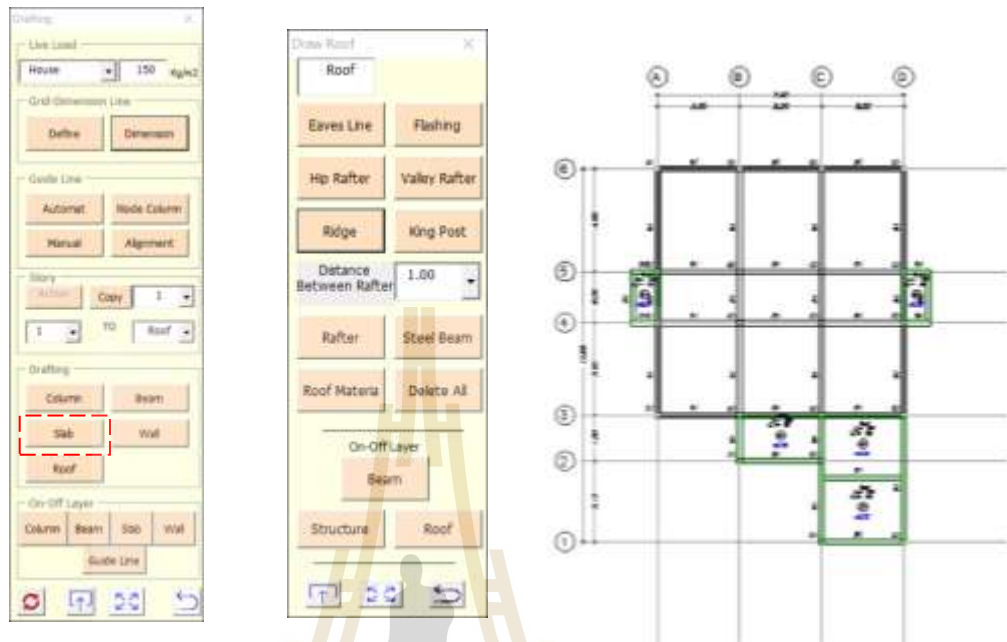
คัดลอกข้อมูลไปชั้น Footing
